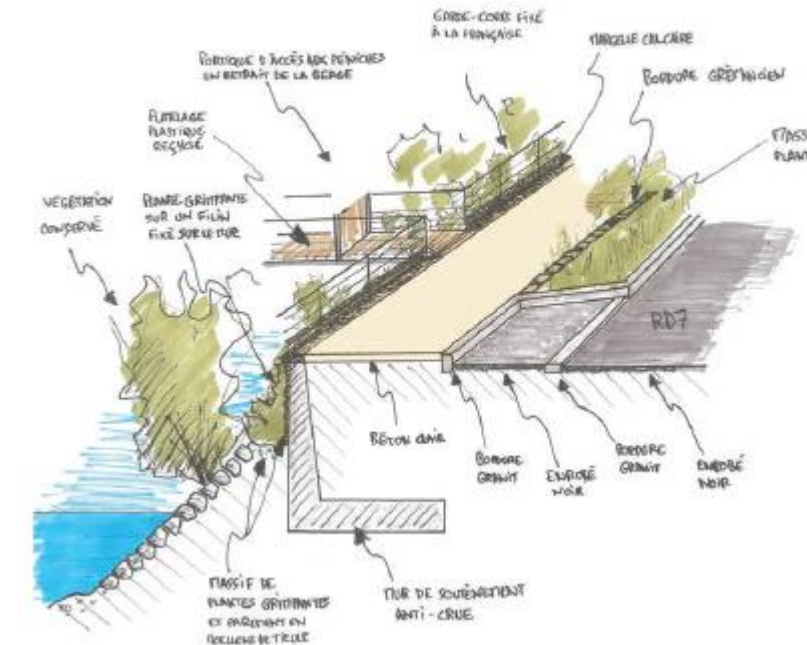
Bloc-diagramme de principe sur les zones avec murs de soutènement en béton
